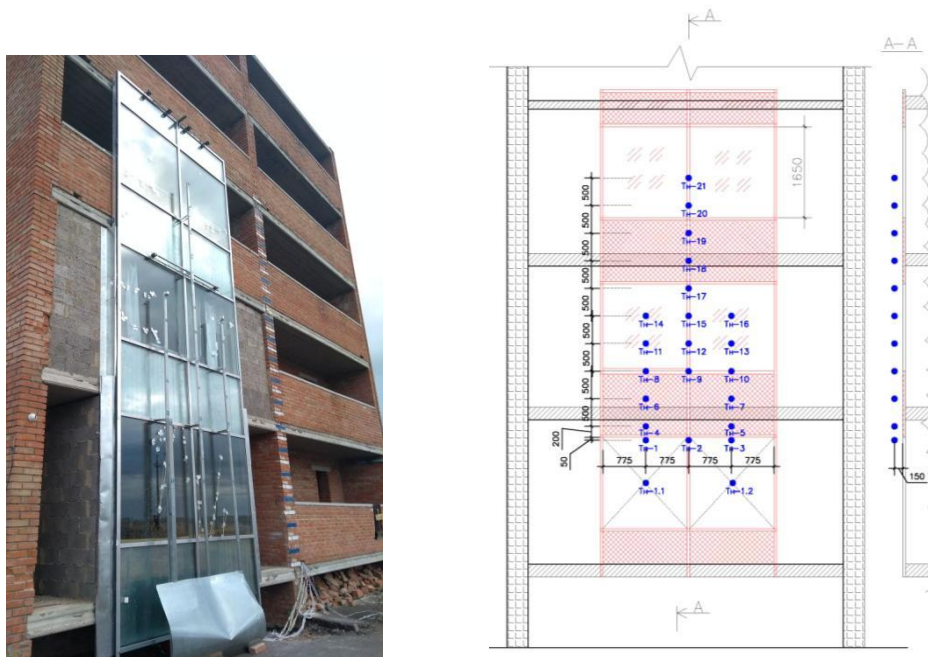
Общий вид навесной светопрозрачной стены со схемой размещения термопар на фасаде здания
